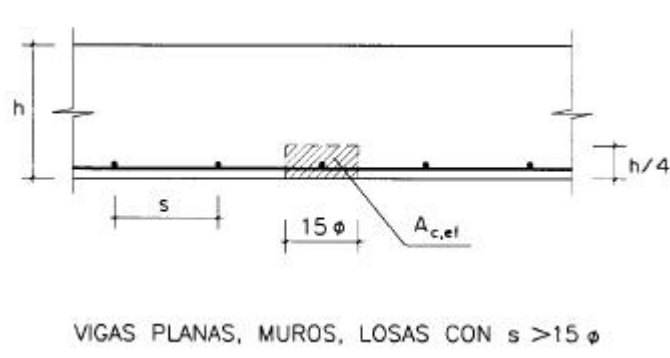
Area de hormigón eficaz para el control de fisuración.
